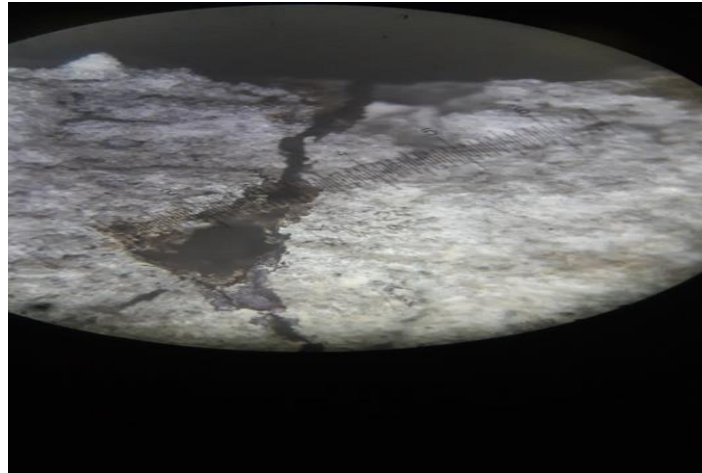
Mesure Première fissure sur la poutre en béton fibré et ferrillé.
